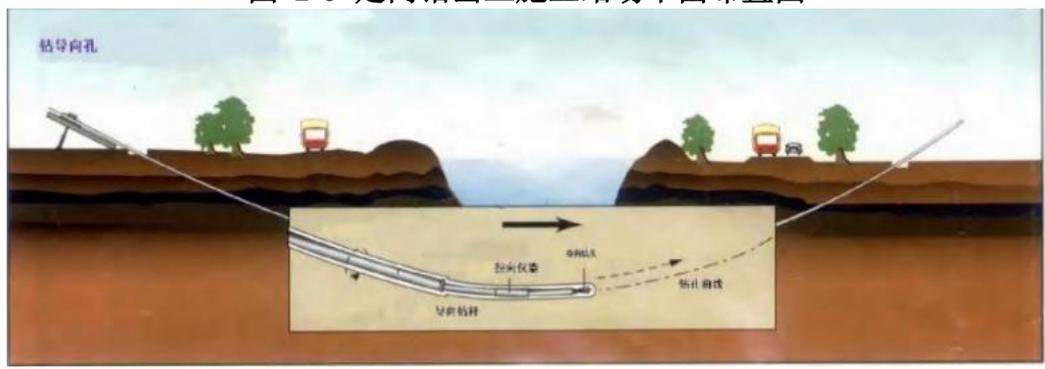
定向穿越管线施工示意图 (钻导向孔)
